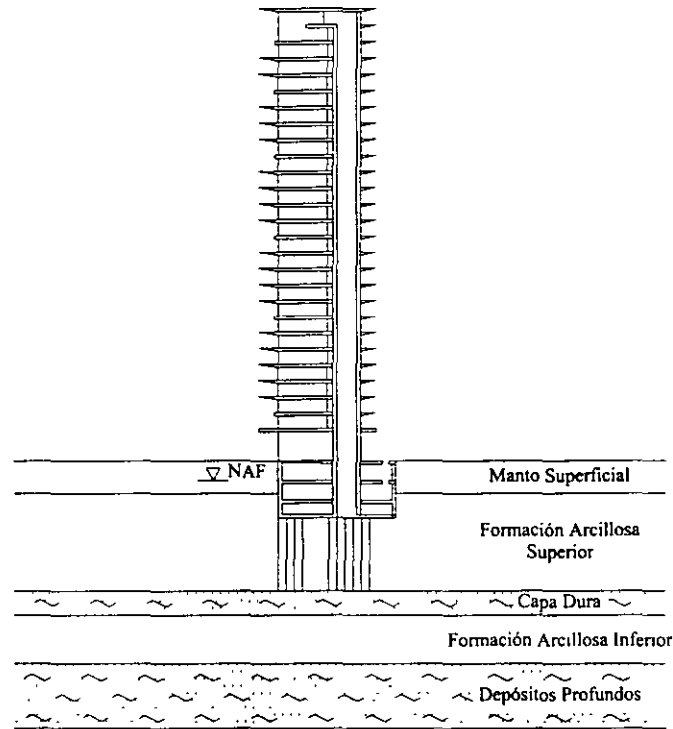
Edificio con pilotes de punta localizado en la zona del lago
